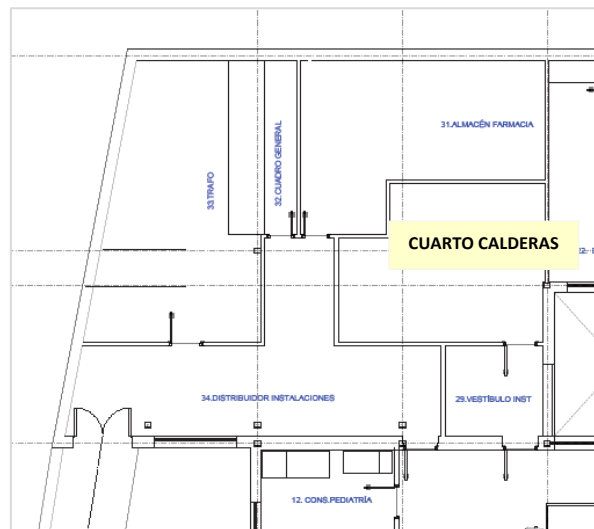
Cuarto de calderas ubicado en la Planta Baja
